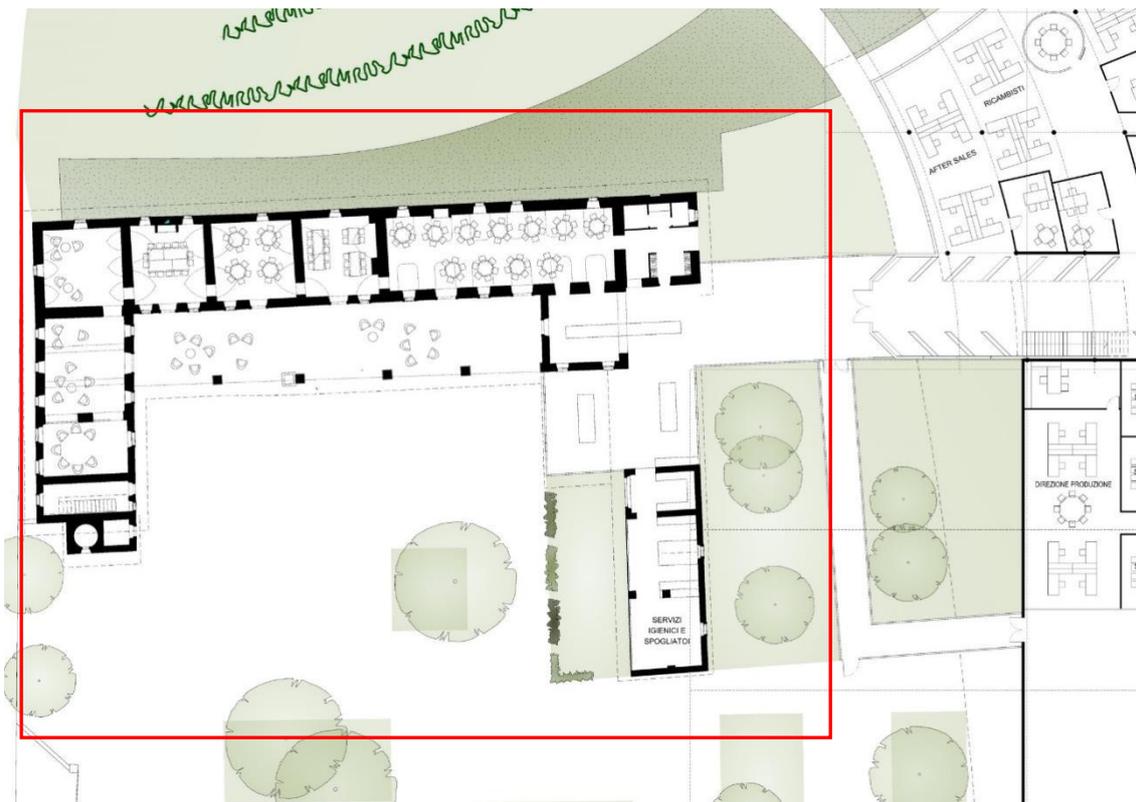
Stato di progetto - Individuazione cascina Colombara
